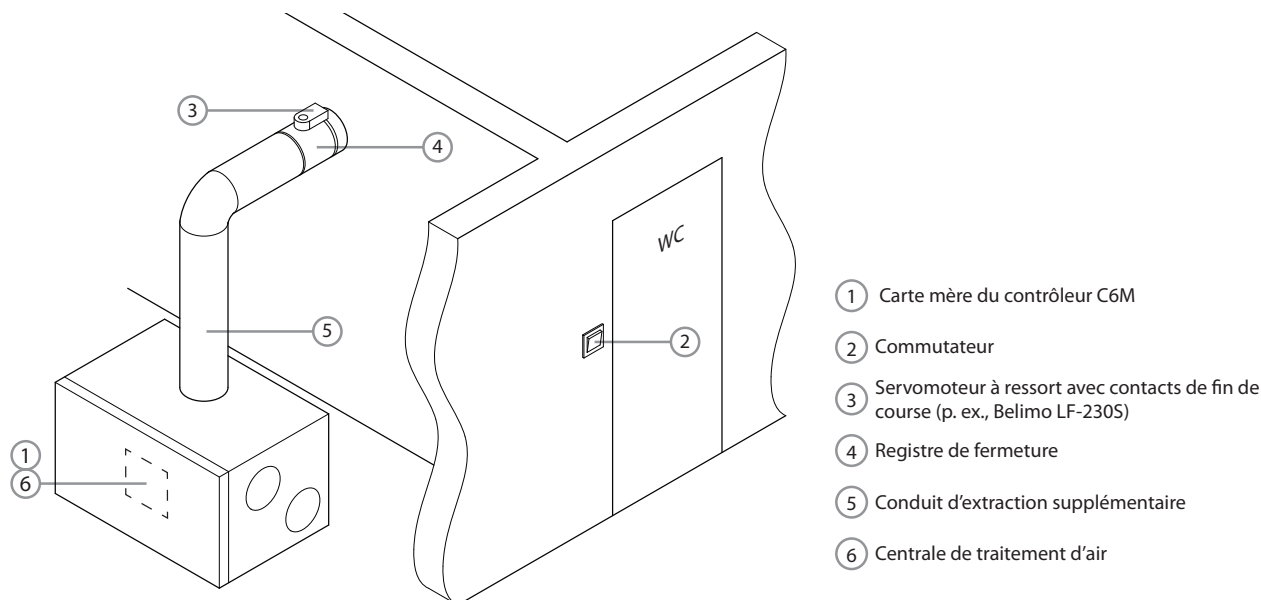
Exemple de montage d'un conduit d'extraction d'air supplémentaire
